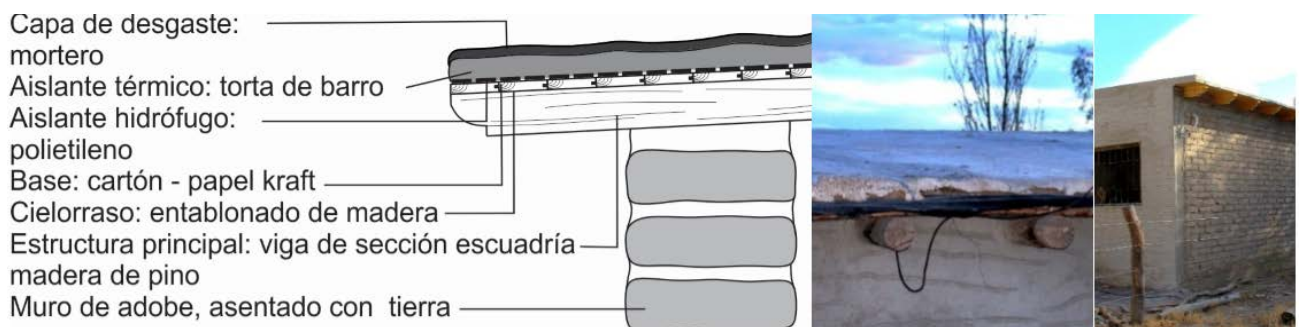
Vivienda en Los Zazos y en Colalao del Valle
